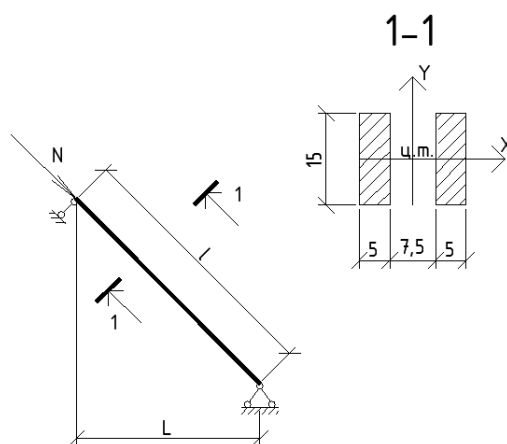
Расчетная схема подкоса стропильной ноги
